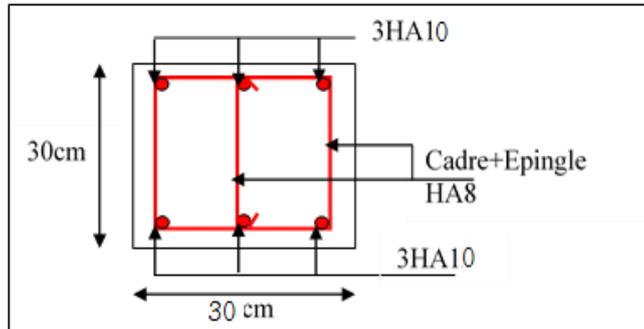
Schéma de ferrailage de la poutre de chaînage.
